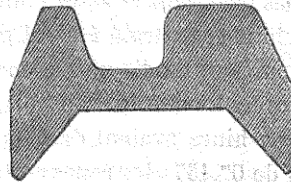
Tramways de Leipzig. Section du rail. 15 kil. par mètre courant. Échelle 1/2.
